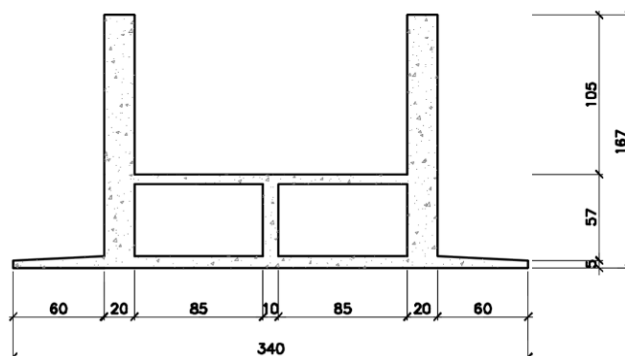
Projeto estrutural: corte transversal típico. Dimensões em (cm)
